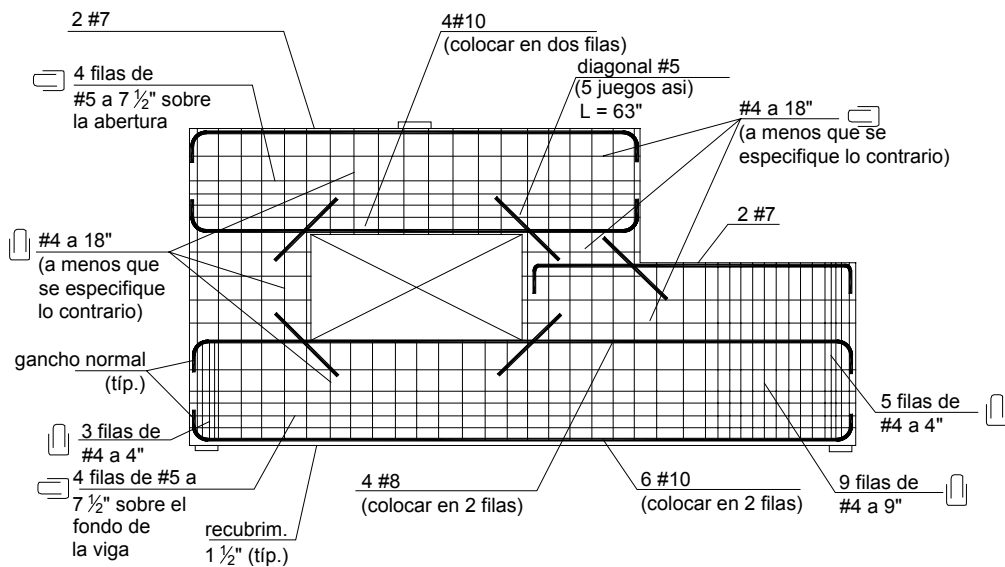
Disposición final de las armaduras de acuerdo con el modelo de bielas y tirantes
